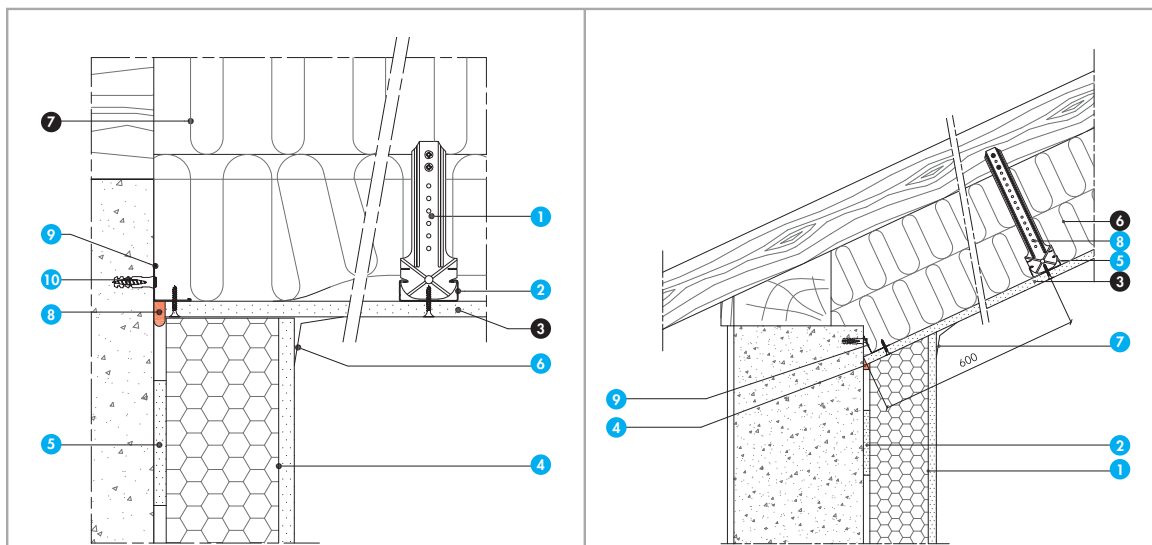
Étanchéité à l'air de la jonction plafonds/support/doublage
